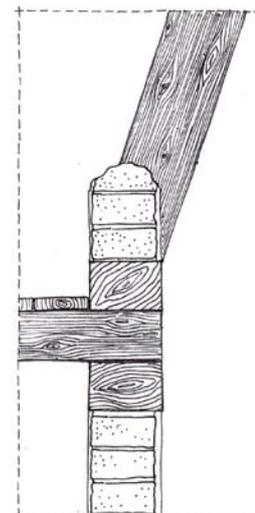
Salida de plano de la imprenta de madera en un muro entramado.
